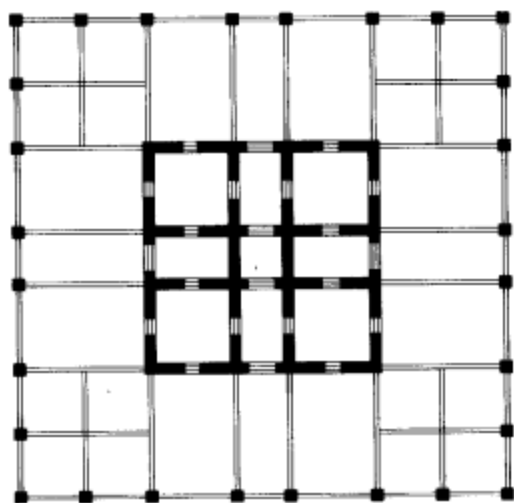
钢框架-钢筋混凝土核心筒典型结构平面图
